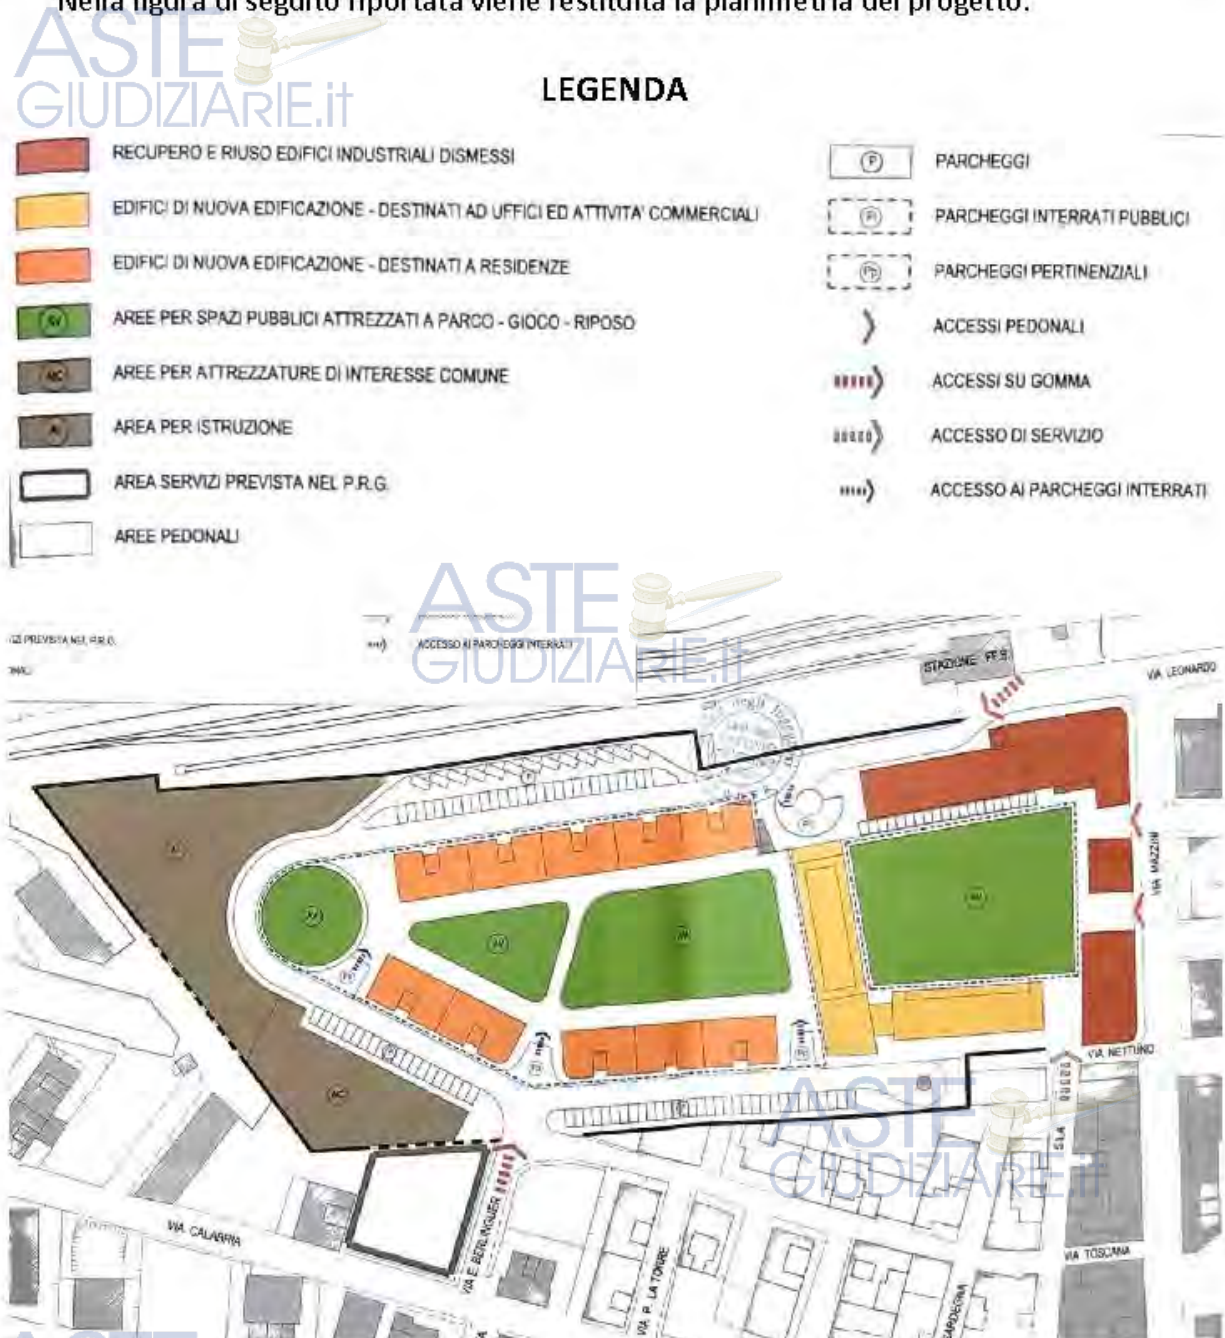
Planimetria Generale del Lotto "Progetto di riqualificazione e di recupero del complesso dell'ex Distilleria Giuffrida" (agosto 2011).
